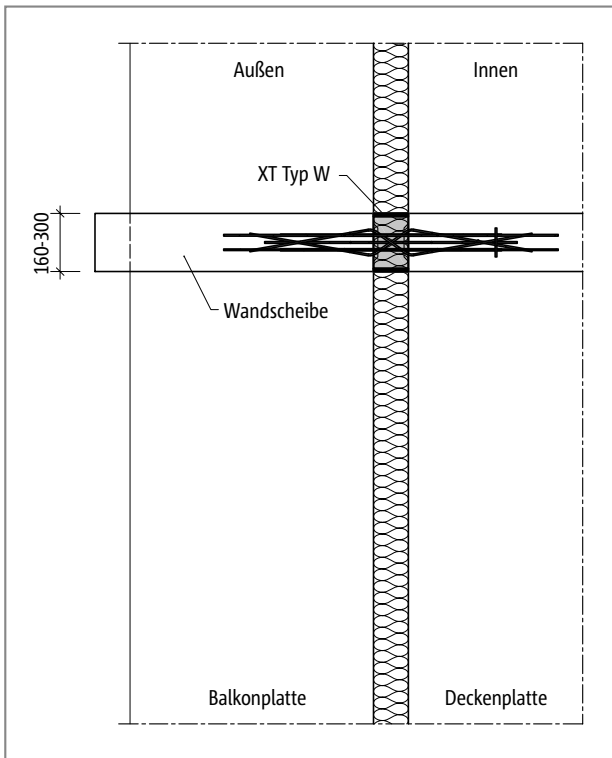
Schöck Isokorb® XT Typ W: Grundriss; Balkonkonstruktion mit wärmege-
